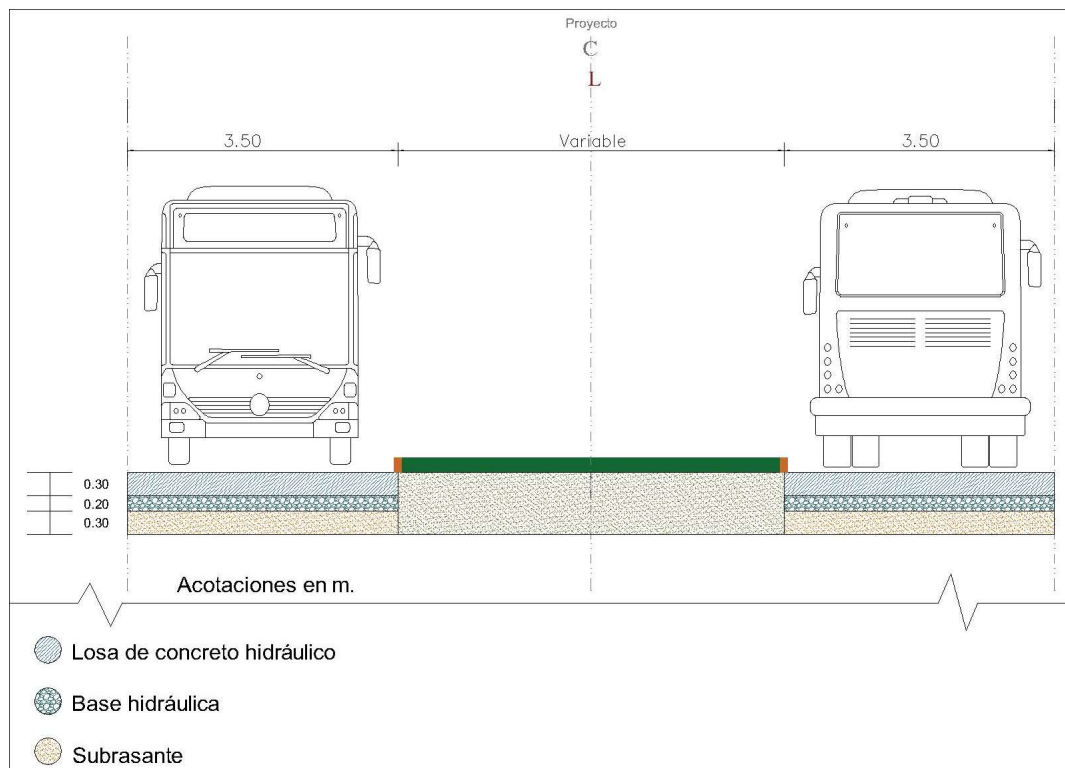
Sección tipo para el pavimento de los carriles del BRT (Elaboración propia).
